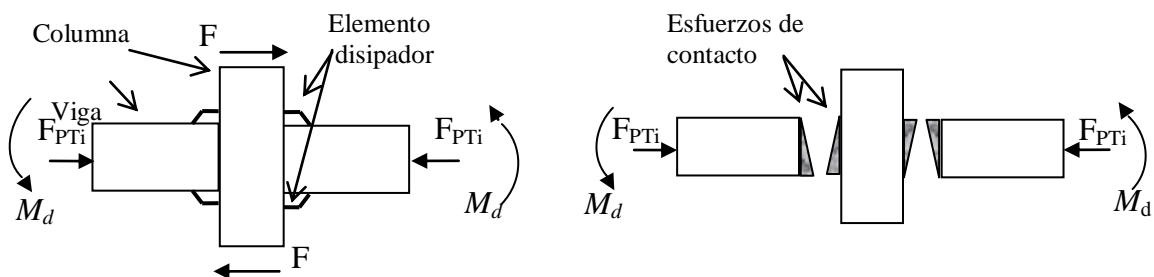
Conexión viga-columna con MPDE en descompresión: ensamblaje completo y diagrama de cuerpo libre.
